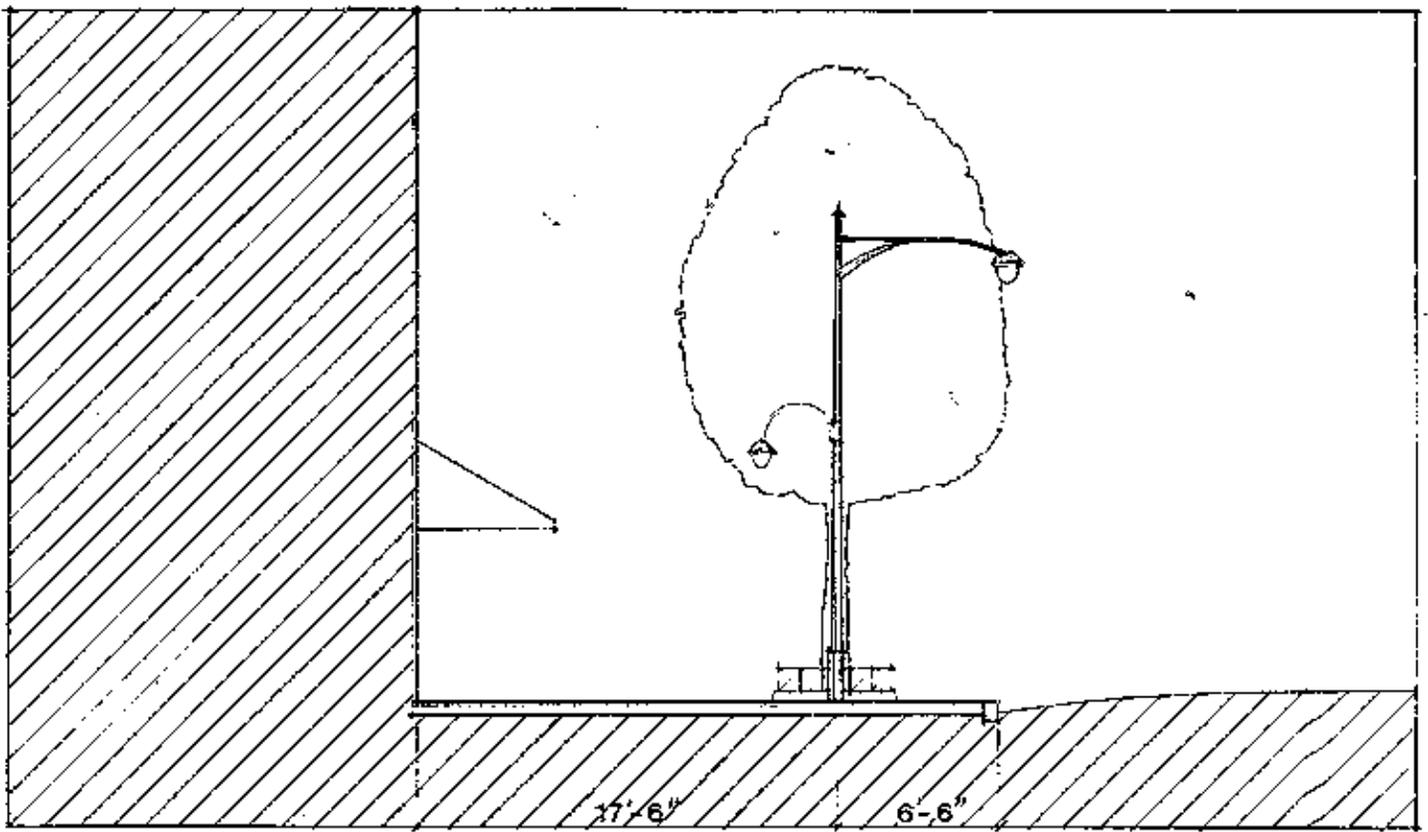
Plan et Élévation du trottoir Archives de la Ville de Montréal
